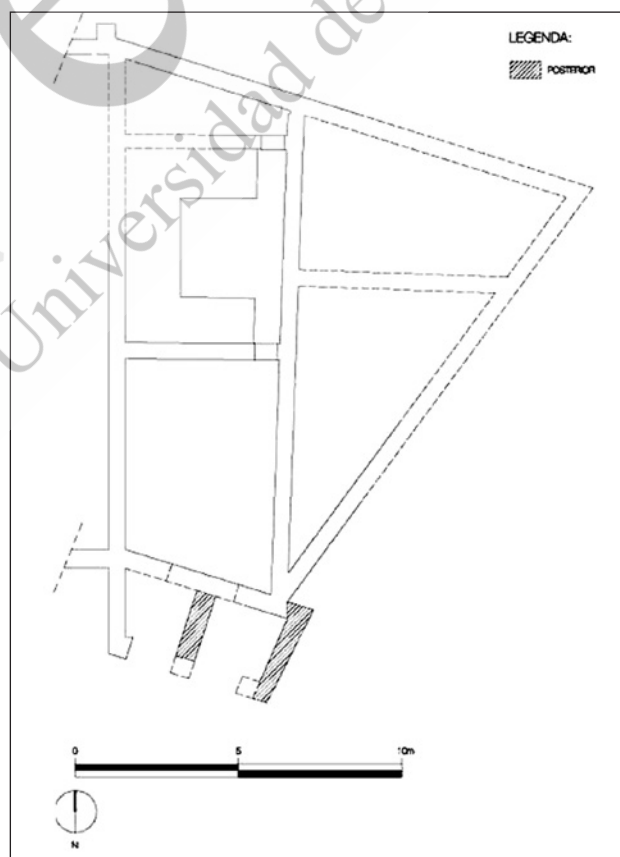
Edifício das latrinas do fórum. Planta reconstituída.
